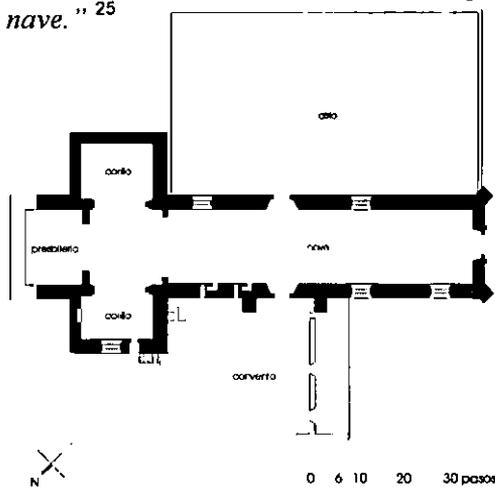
Planta, Copanaguastla. Levantamiento, López Bravo
